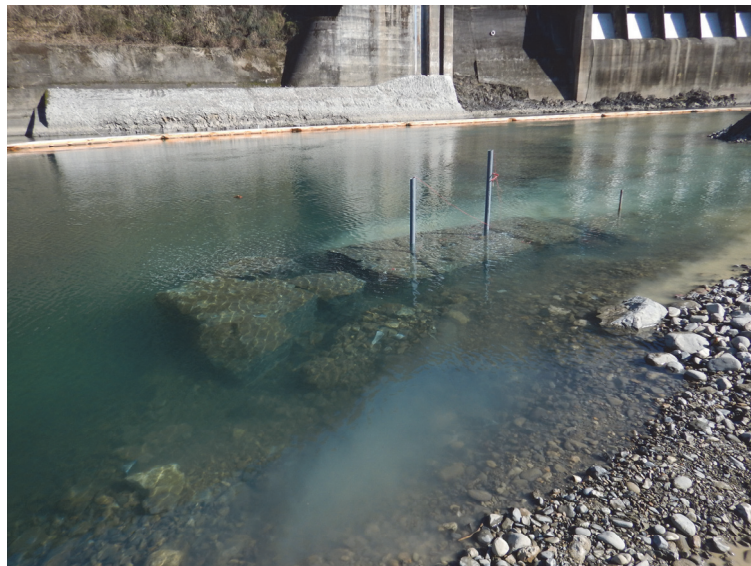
第 I 期工事設置導流壁の撤去状況
